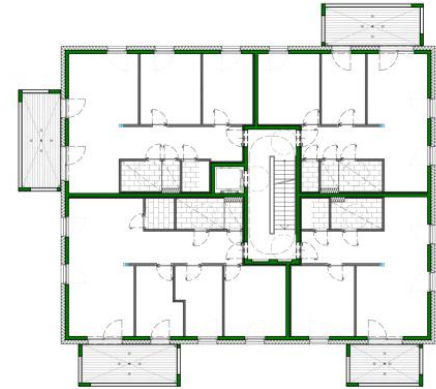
Regelgrundriss Forschungsprojekt Haus B
